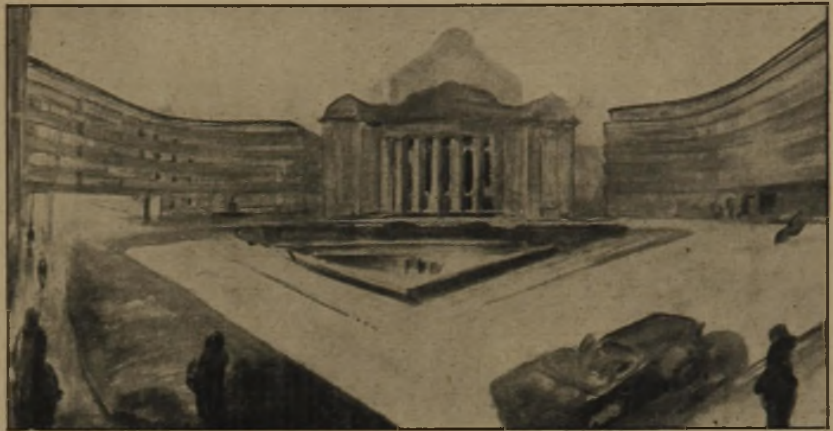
Platzwand mit dem Theater und Überbauung der Ausfallstraßen.
